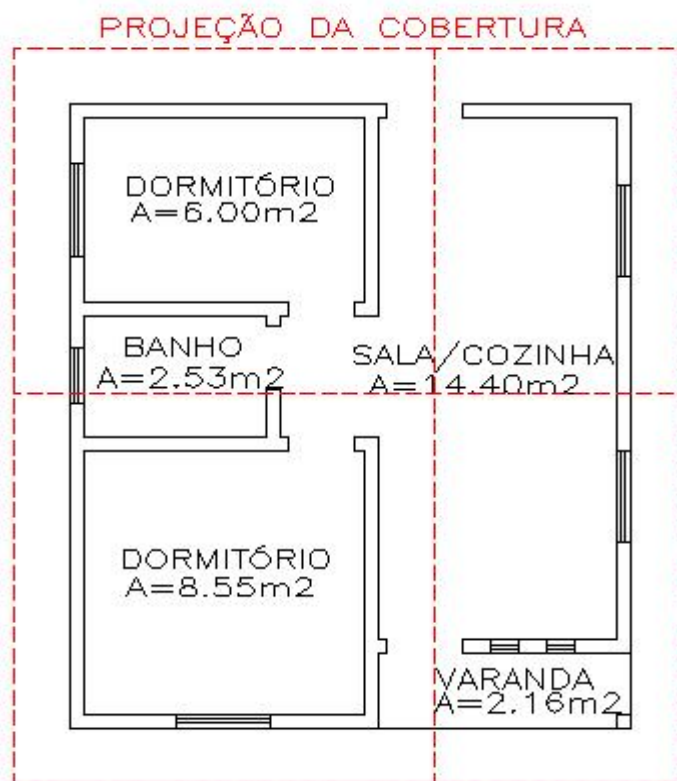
Planta baixa modelo casa de interesse social (área de 40,50m²).
